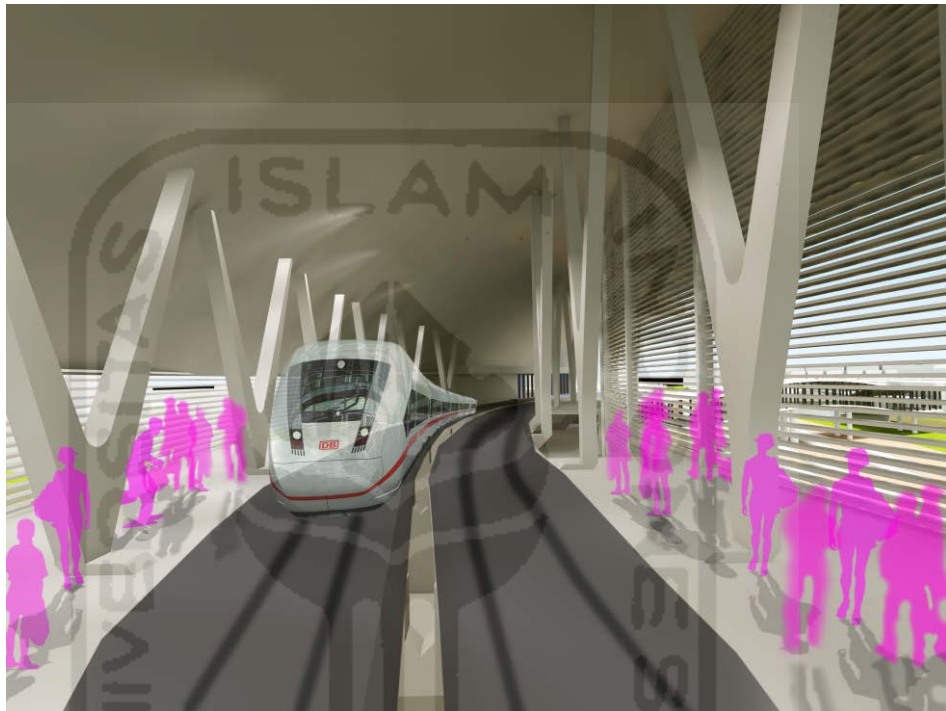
merupakan gambaran konsep sebagai penyelesaian persoalan desain terkait dengan struktur bangunan. Tentang perancangan mengenai fungsi bangunan stasiun MRT yang memiliki struktur dengan penyediaan fungsi didalamnya berupa ruang publik dan sebagai struktur yang dapat mendukung konsep penyediaan energi tenaga surya.
